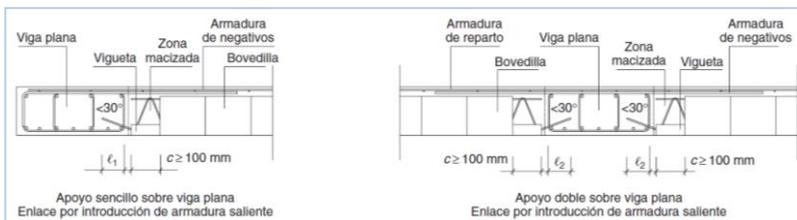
y 26. Apoyo sobre viga plana. Enlace por introducción de la armadura saliente
